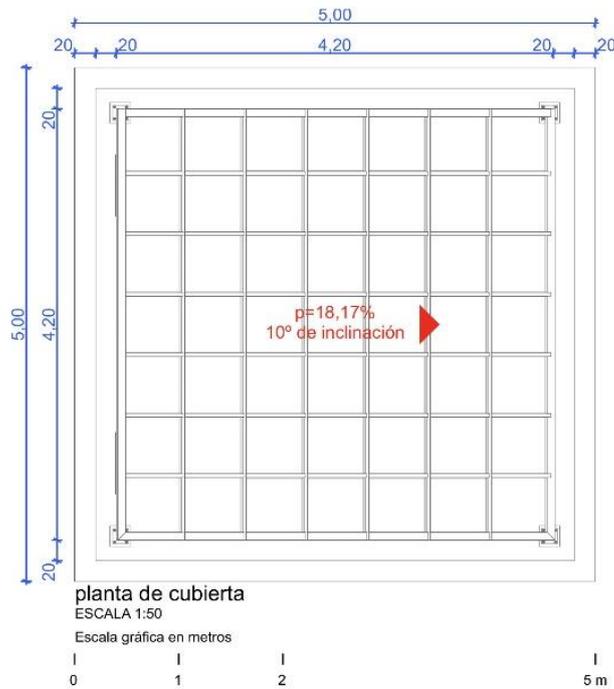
Plano de Planta del Techo o Cubierta (Fuente Propia)
